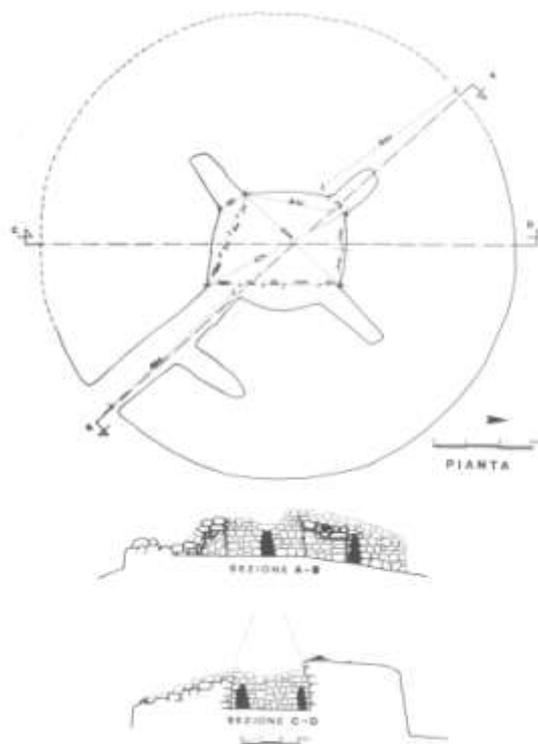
Nuraghe Biancu: planimetría y secciones (MORAVETTI, 2000b: fig. 9)
